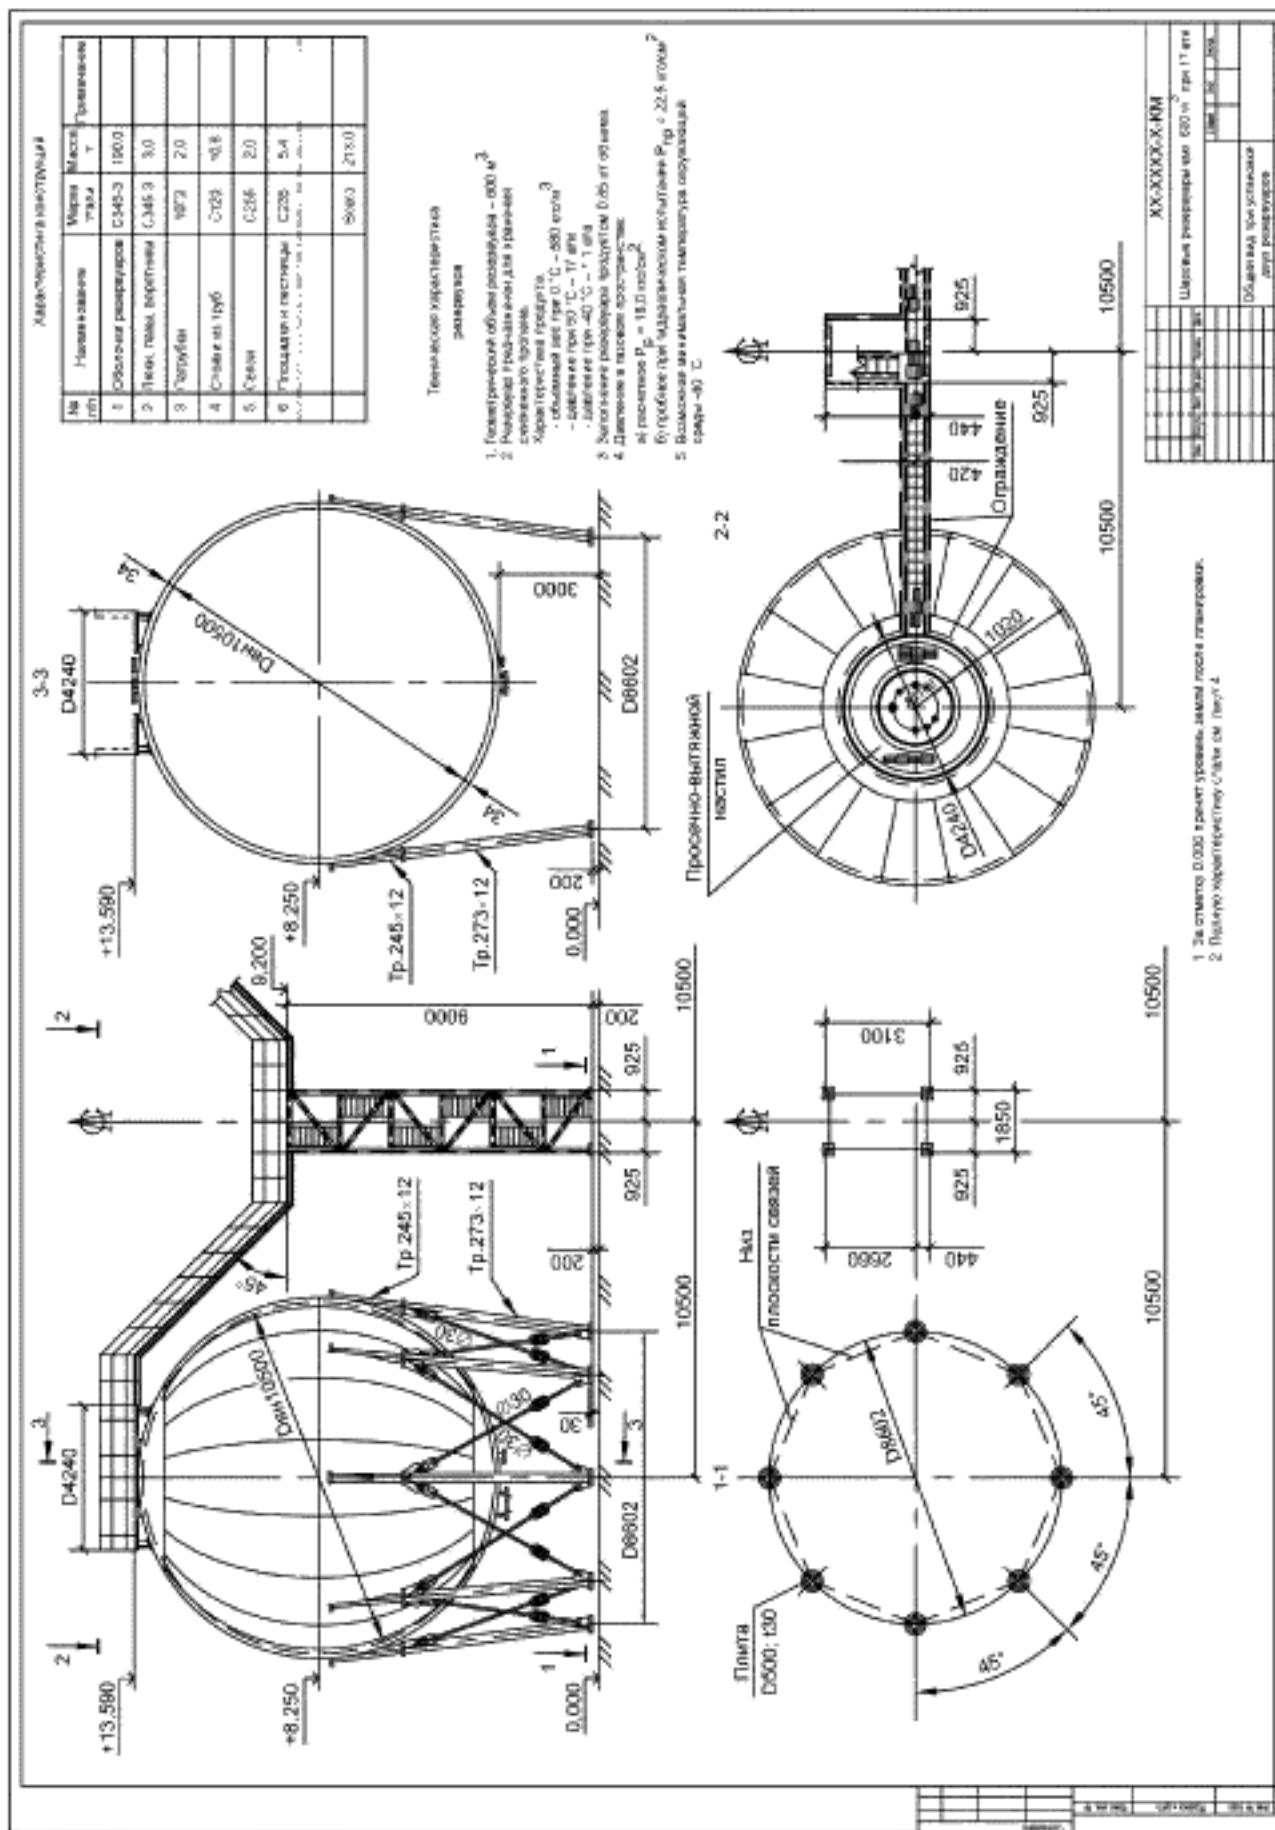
Общий вид при установке двухрезервуаров
